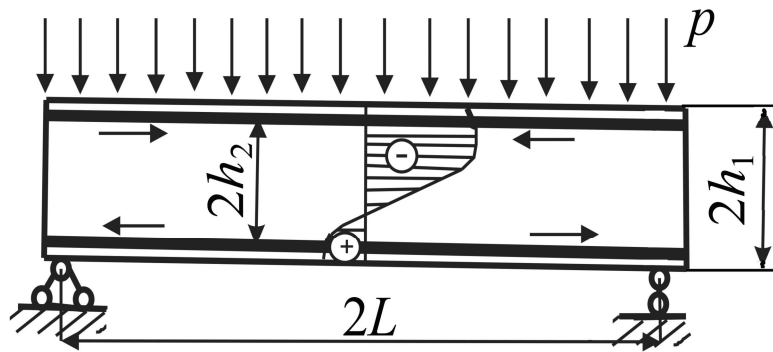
Схема навантаження залізобетонної балки з наперед напруженою арматурою.
